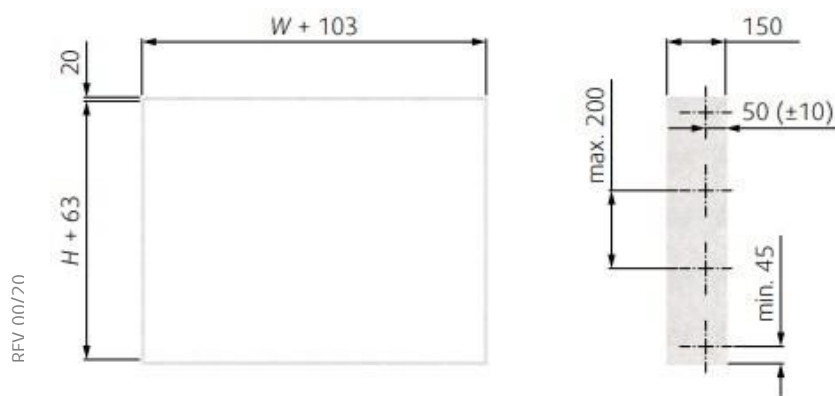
Dimensioni (mm) di K1-S-SA2L con posizione delle viti
